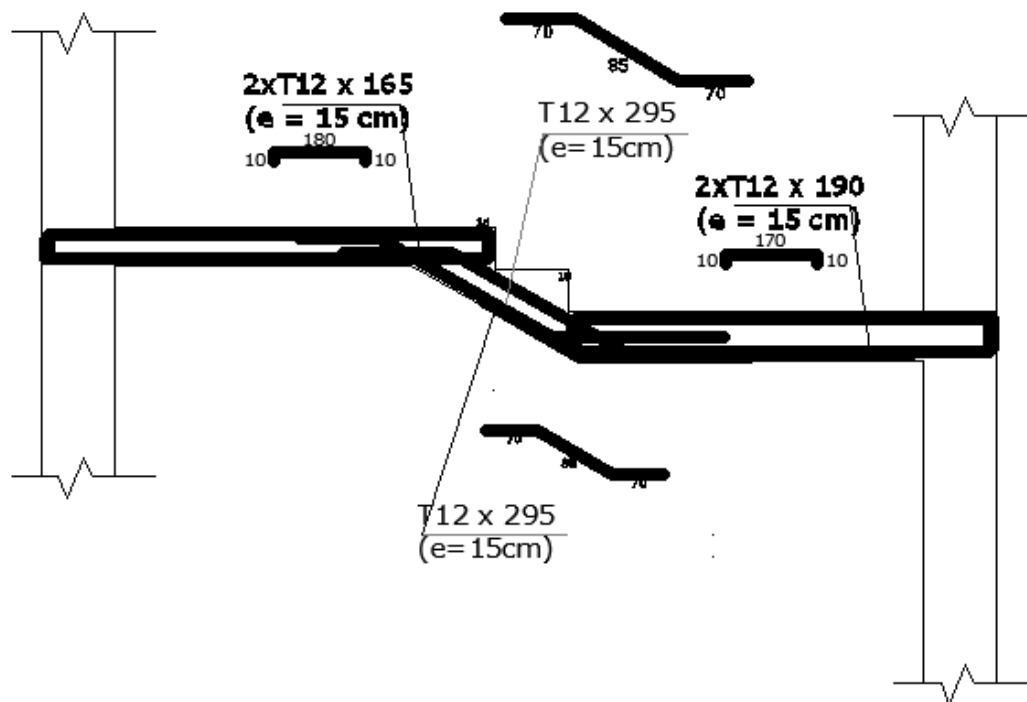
Ferrailage de coupe B-B (escalier2)
